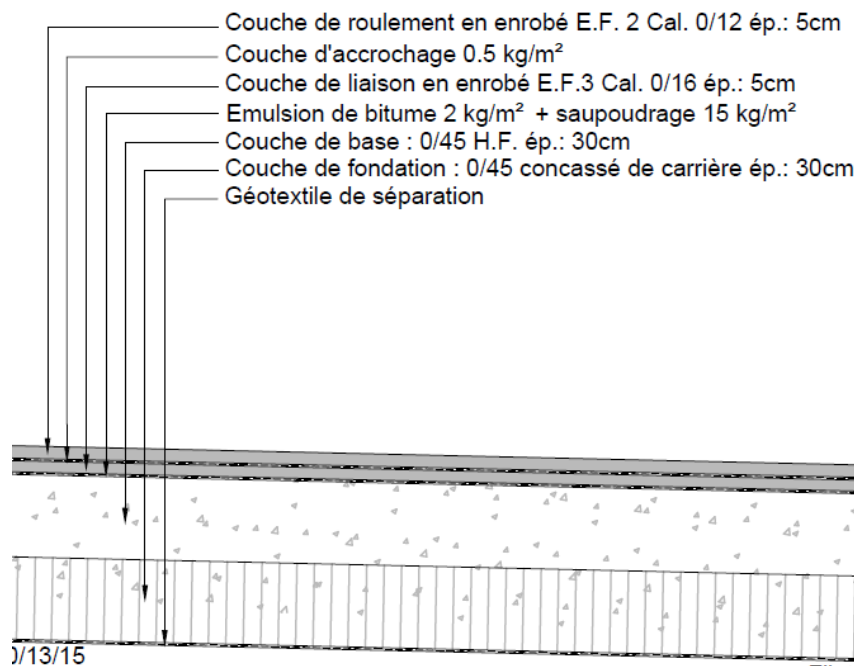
Aufbau des Oberflächenbelags, Stand 14.08.2020 (Schroeder&Associés 2020). Gesamtplan des Schnittes A-A findet sich in Anhang 01.
